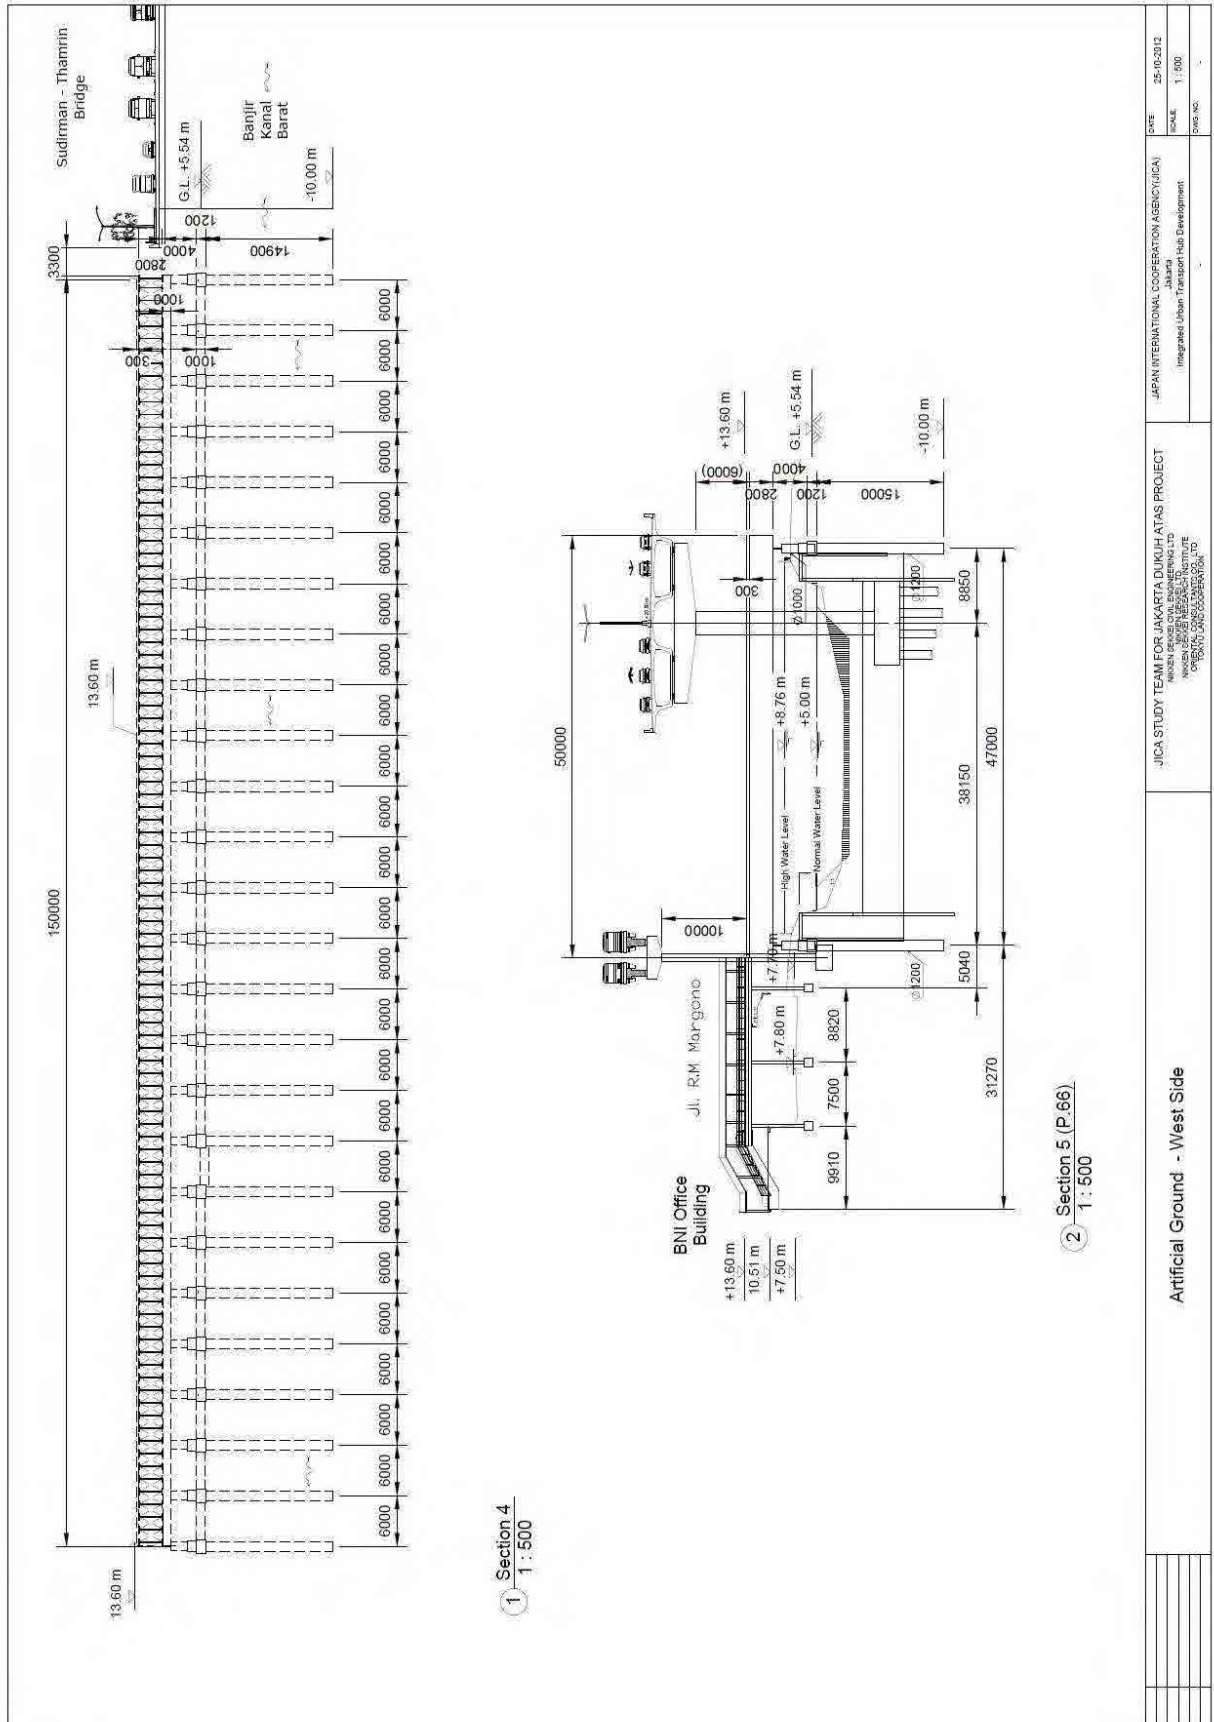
西側人工地盤断面図 (出典：調査団)
